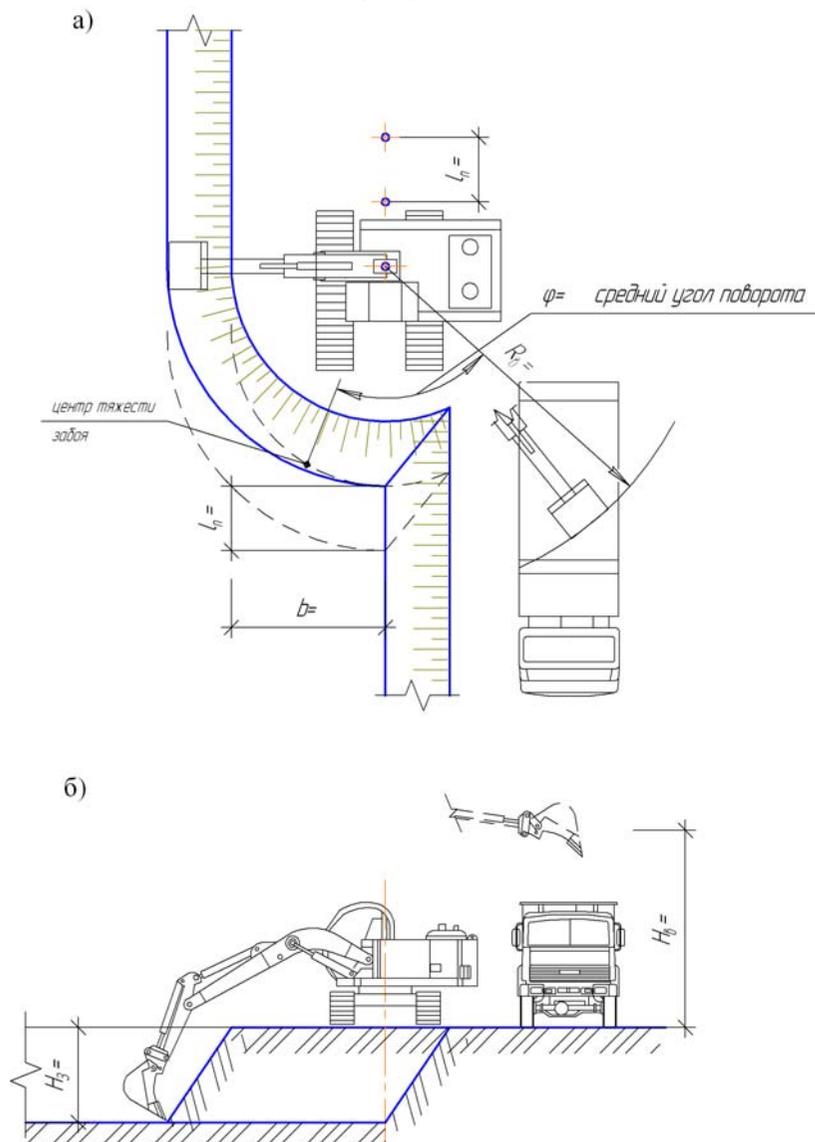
Схемы проходок: а – план, б – разрез
